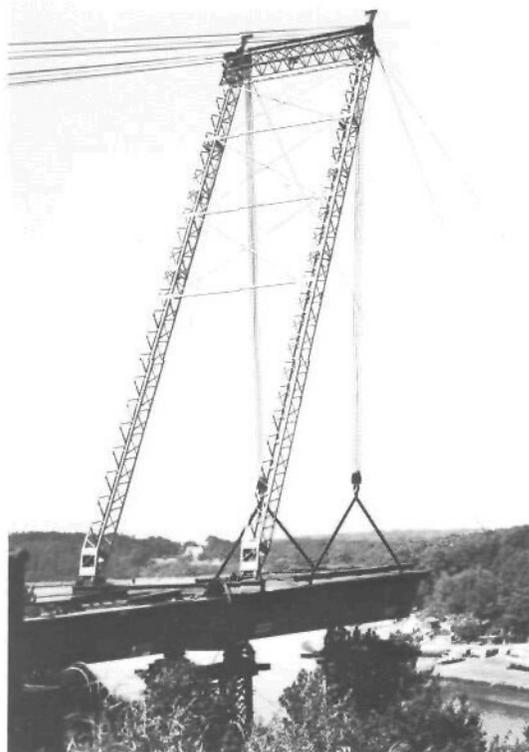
Mise en place du tronçon de clavage, d'un poids de 40 tonnes environ et de 18 mètres de longueur.
